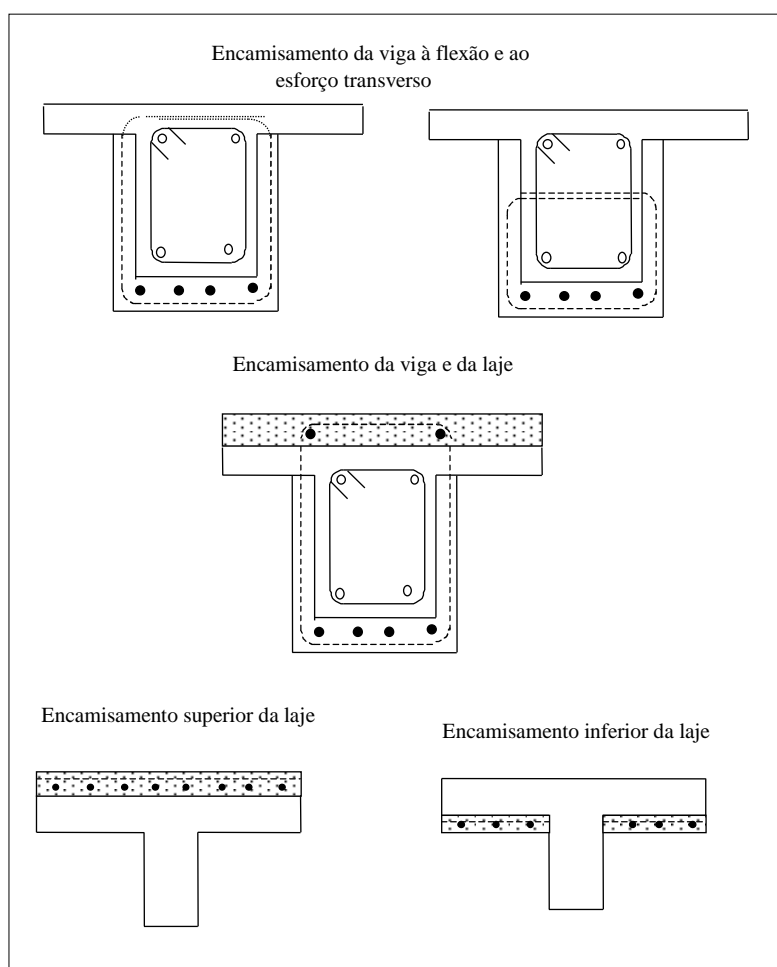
Encamisamento com betão de vigas e lajes [46].
